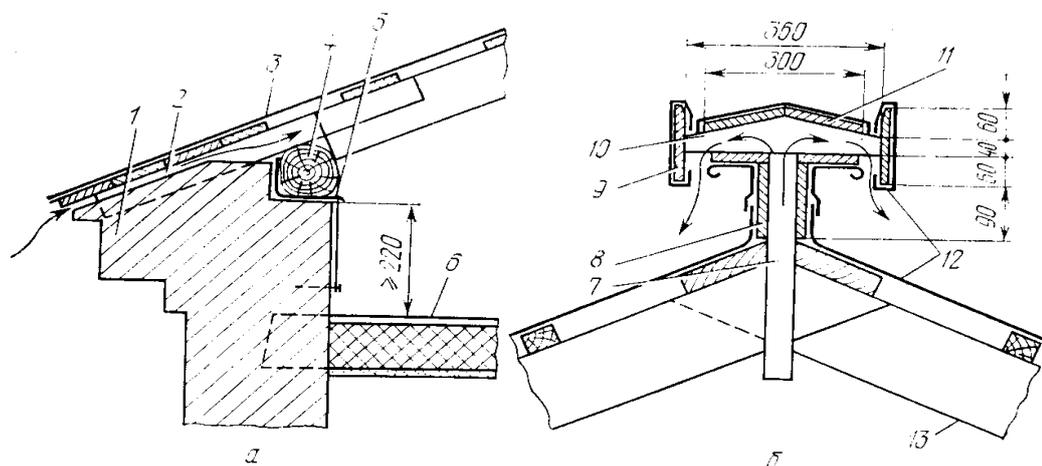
Схема вентилирования чердачного помещения при помощи приточных (а) и вытяжных (б) продухов: 1 – наружная каменная стена; 2 – приточный карнизный щелевой продух; 3 – кровля; 4 – мауэрлат; 5 – гидроизоляция; 6 – чердачное перекрытие; 7 – стойка; 8 – обшивка из досок; 9 – отражатель из досок; 10 – кобылка; 11 – обрешетка коньковой щели; 12 – кровельная сталь; 13 – стропильная
